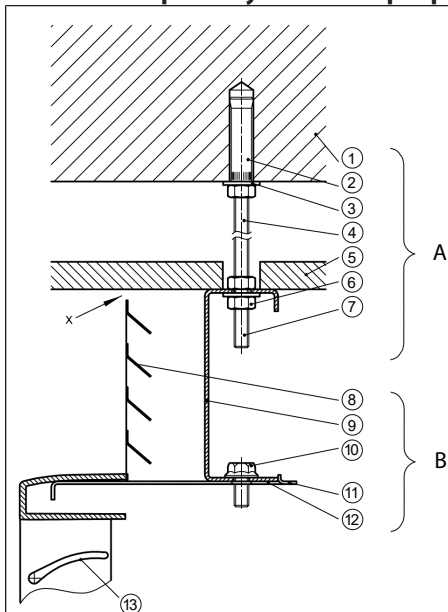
Монтаж устройства Ultra на промежуточном перекрытии
